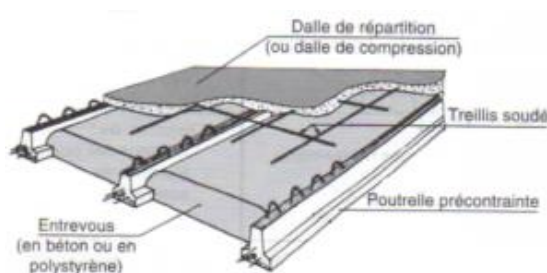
Les différents composants d'un plancher poutrelle hourdis (toutsurlebeton,2021).
